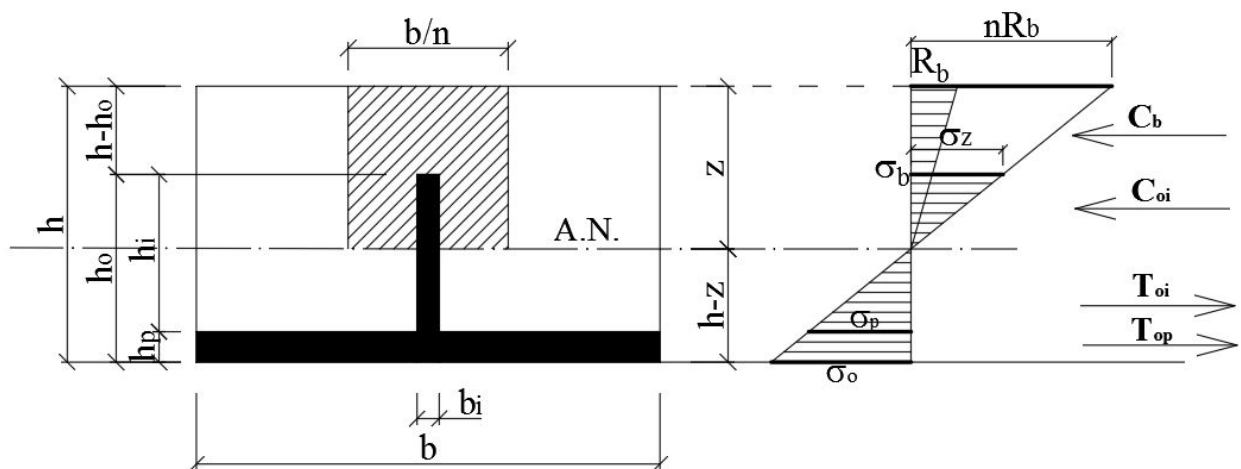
1. Model de calcul al structurii mixte oțel-beton cu structură metalică din platbenzi
